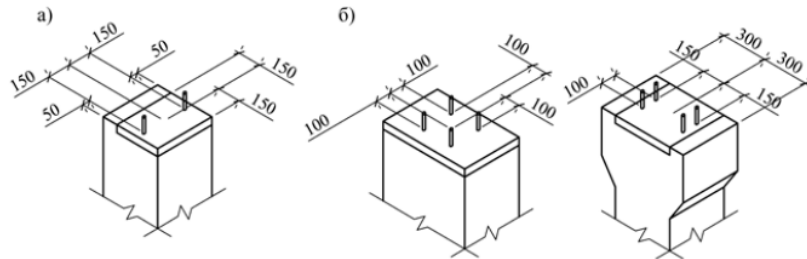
Закладні деталі в колонах безкранових (а) та ОВБ з мостовими кранами (б) для кріплення кроквяних конструкцій
